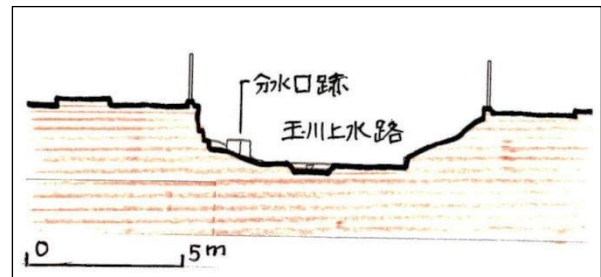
幡ヶ谷分水取水口断面略図 (上流部)
